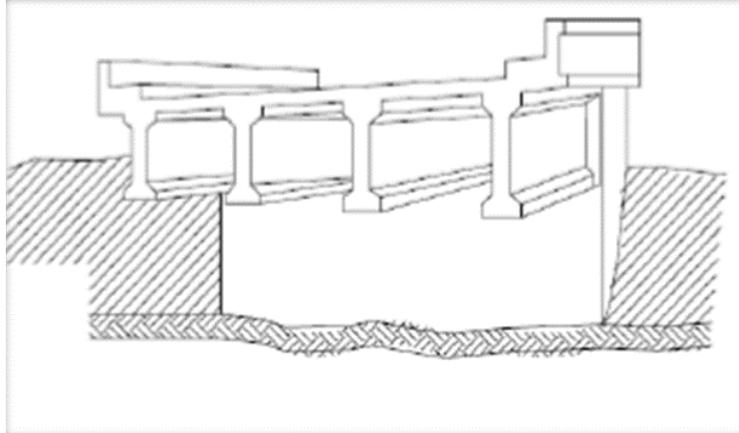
Puente de losa con viga de concreto pretensado.
